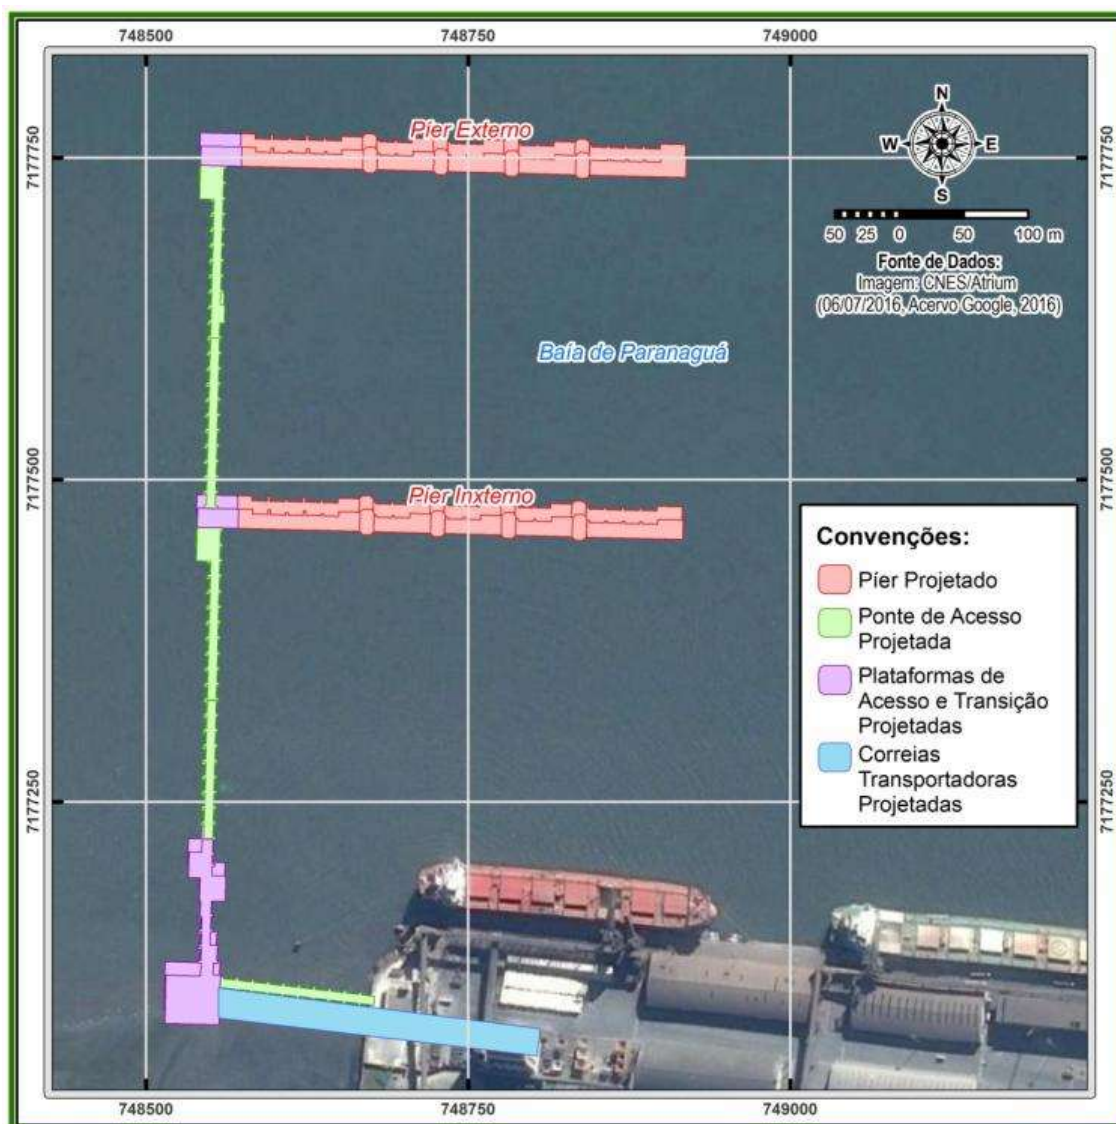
Layout do Píer em F com identificação das instalações.
